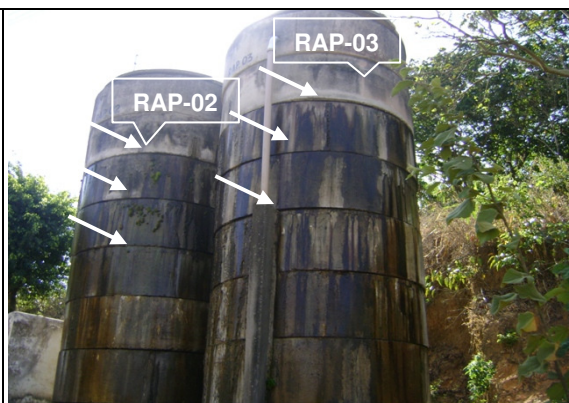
RAP's-02 e 03: Vazamento na estrutura.
